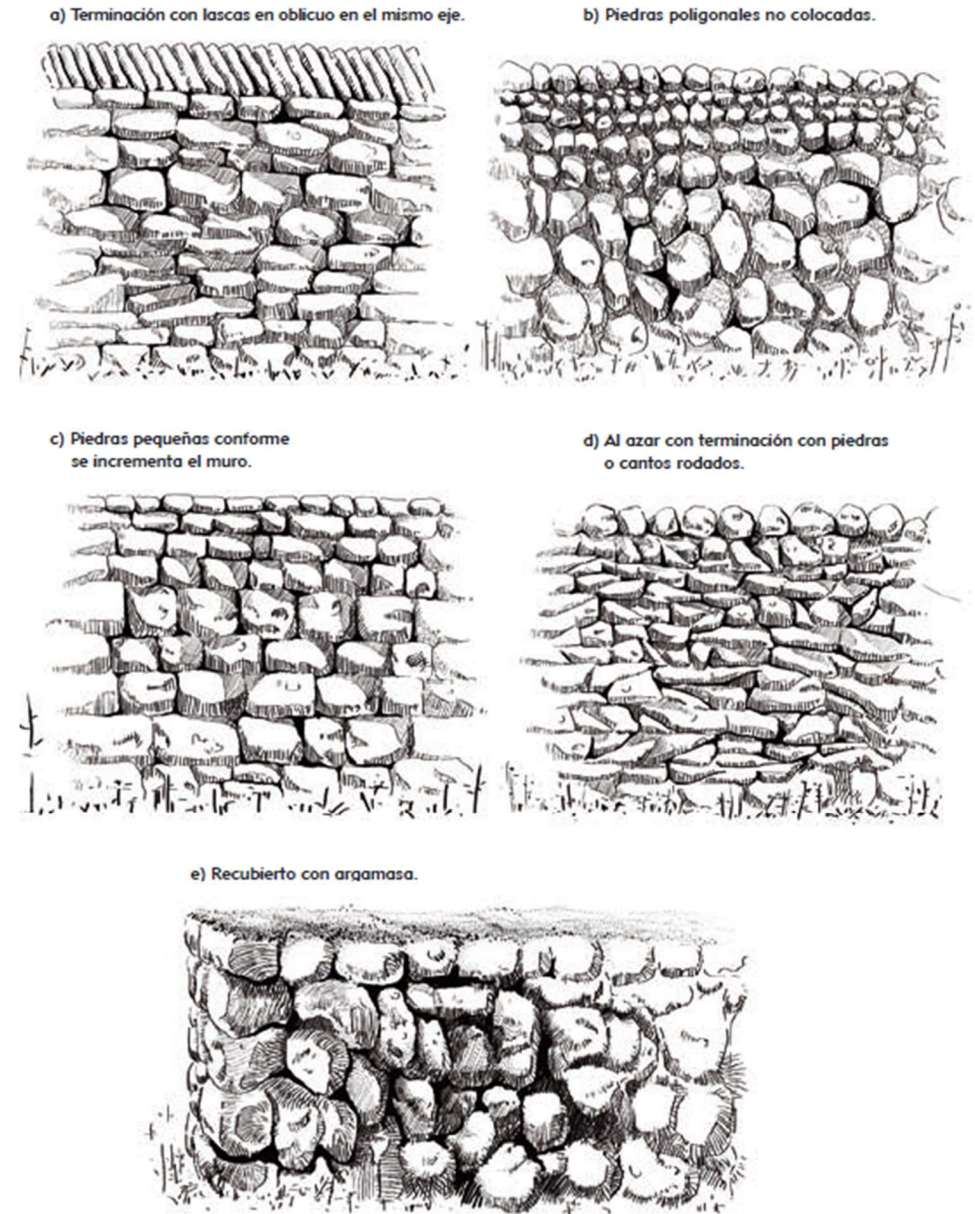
Soluciones constructivas de muros de mampostería. Construcción en piedra seca. Junta de Andalucía, 2015
